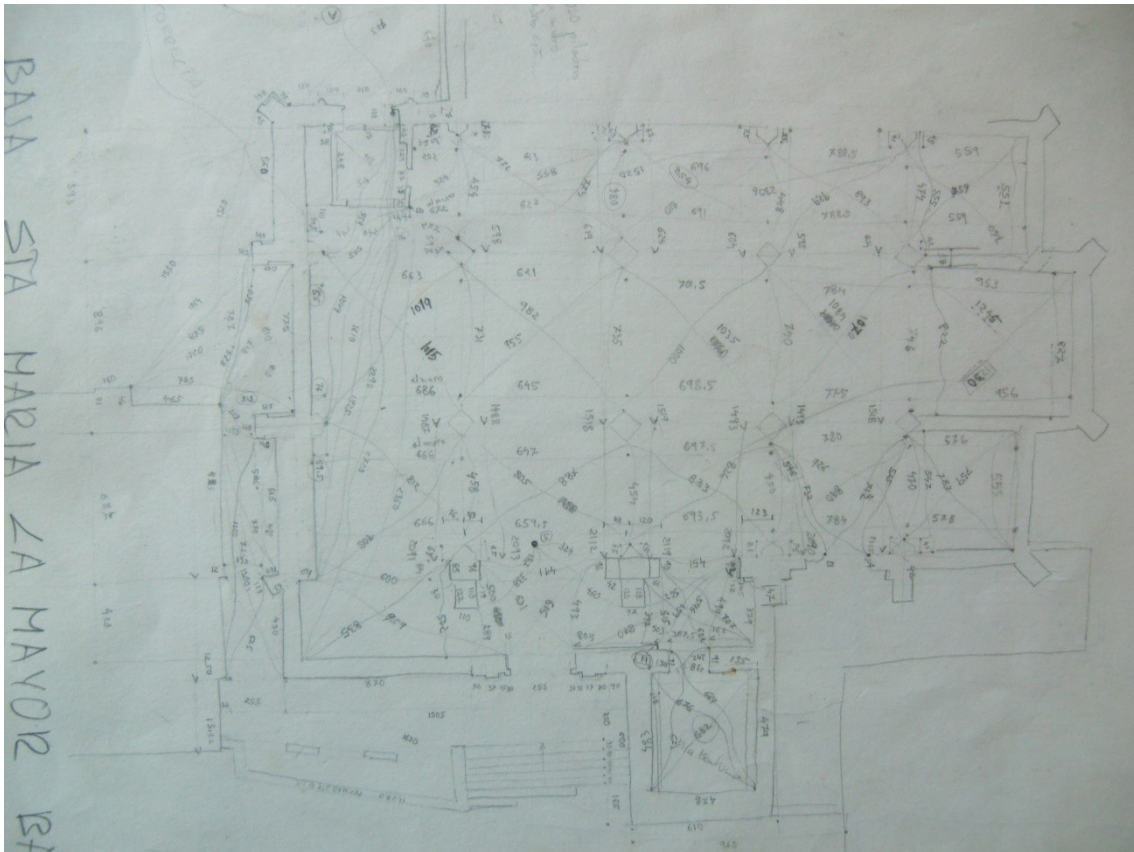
Planta - Croquis del levantamiento realizado por el autor
